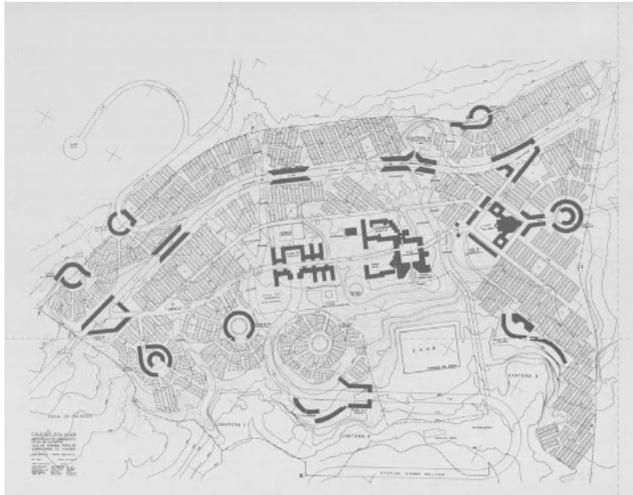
Ciudad Bolívar – Plan general propuesto – no desarrollado.
